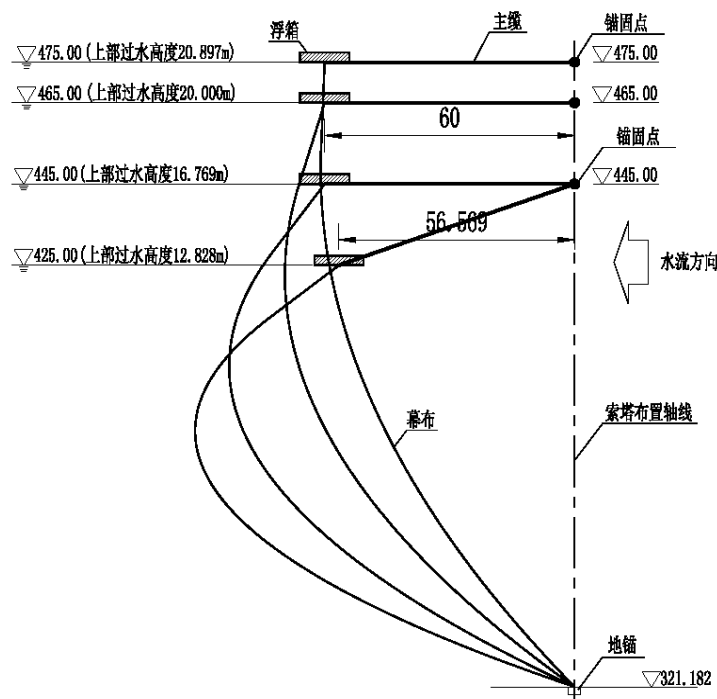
隔水幕墙系统结构典型纵向剖面图
